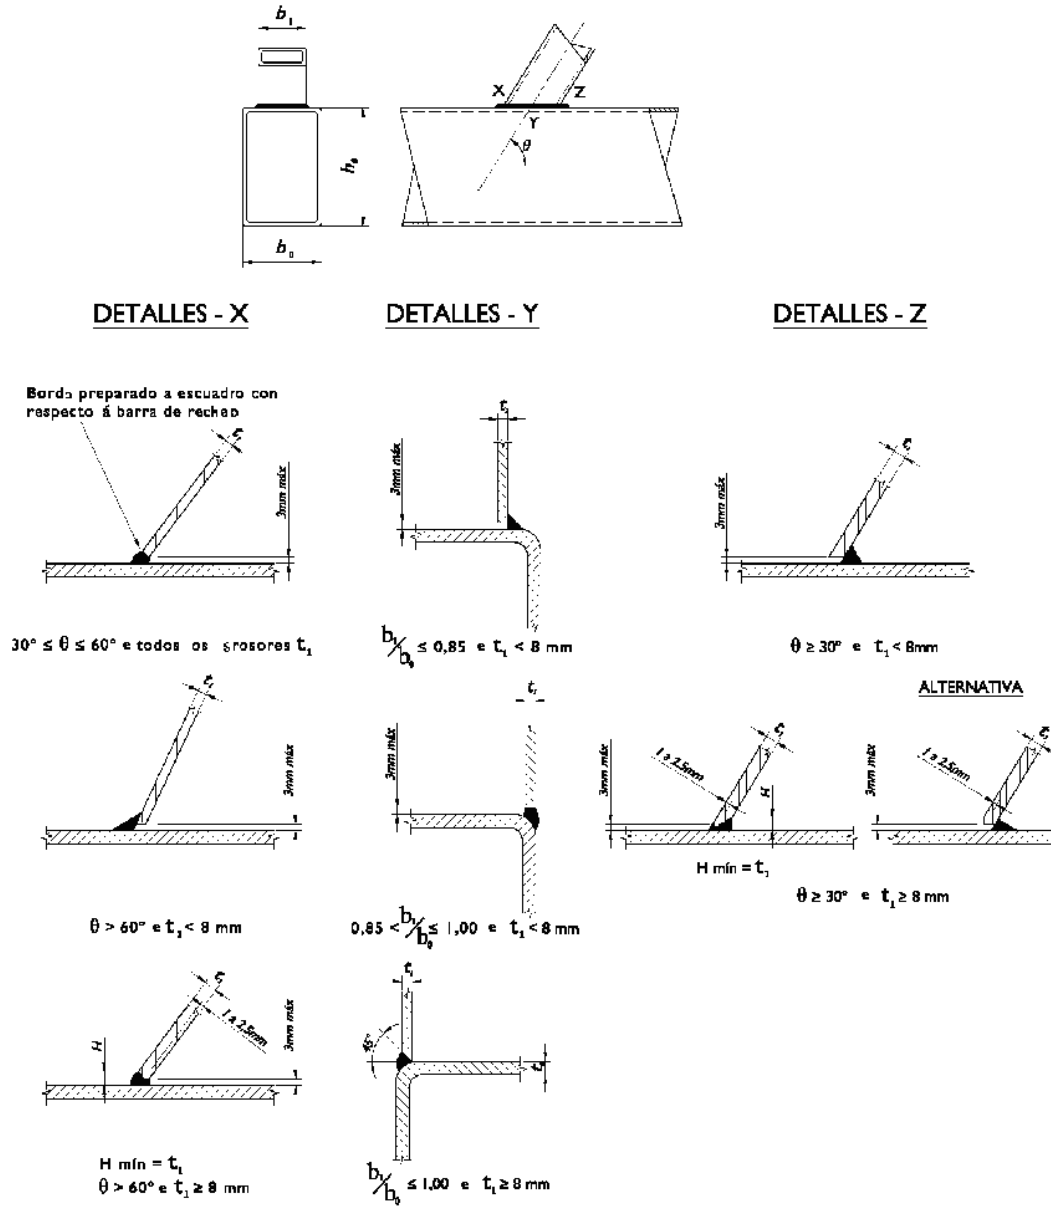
b. Detalles construtivos de soldaduras tipo para perfis tubulares rectangulares
